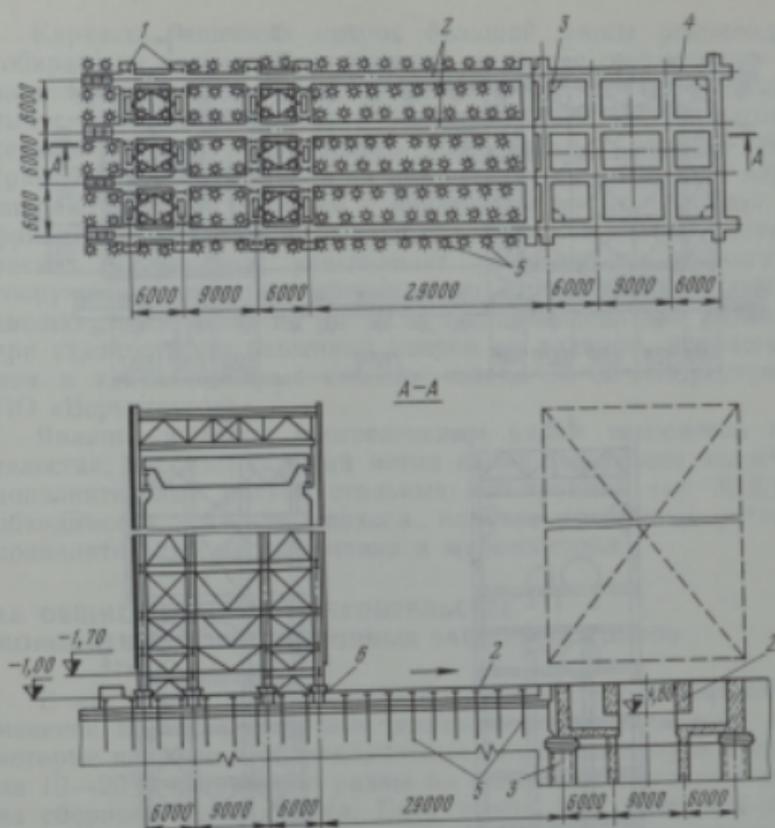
Надвигка башенного копра способом скольжения по четырем слямям: 1 — дополнительные стальные опоры для вывешивания каркаса копра; 2 — арматурные ленточные фундаменты со стальными слямями; 3 — шурфы-фундаменты; 4 — балочная клетка, опертая на шурфы-фундаменты; 5 — термосваи; 6 — опорные башмаки колонн с наклеенной на их подошвы антифрикционной тканью
